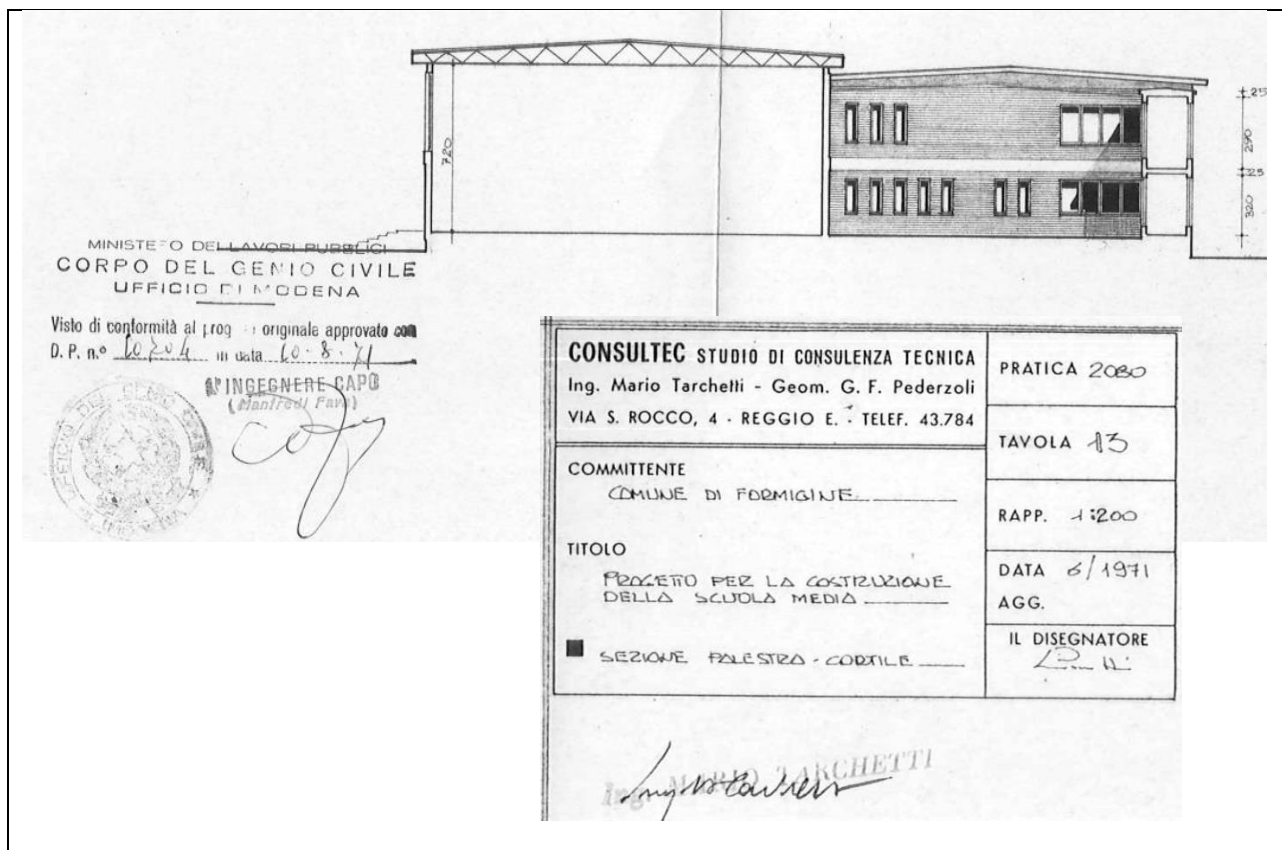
Scuola “A. Fiori” di Formigine: Palestra - Sezione architettonica dell’epoca.
